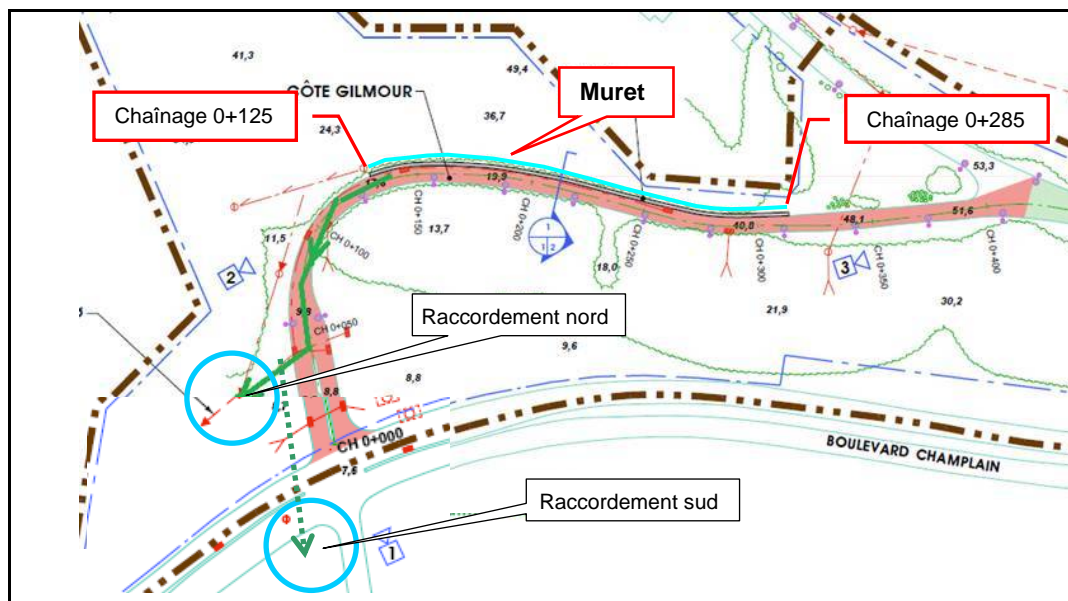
Localisation du muret et des points potentiels de raccordement de la conduite pluviale
